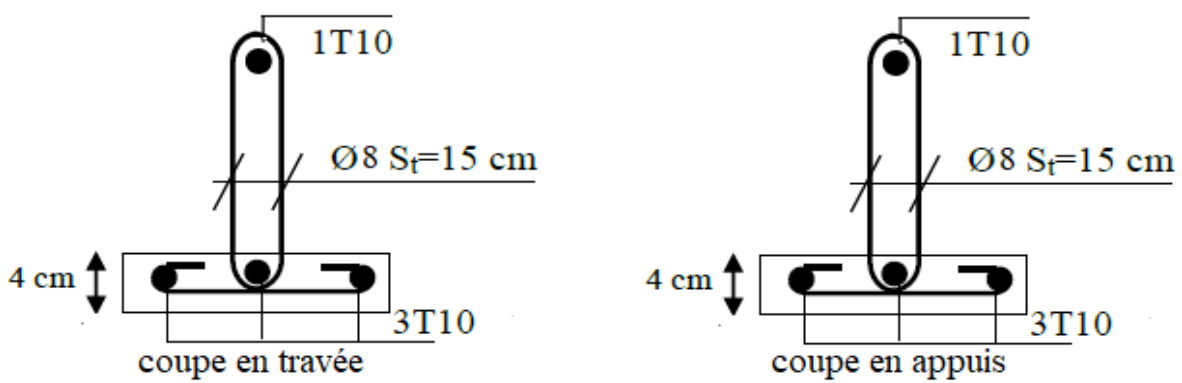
Schéma de ferrailage des poutrelles de rives Plancher terrasse
